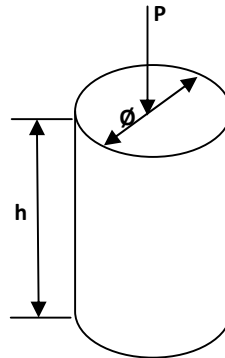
Schéma et forme des éprouvettes ($h = 32 \text{ Cm}$, $d = 16 \text{ Cm}$)
